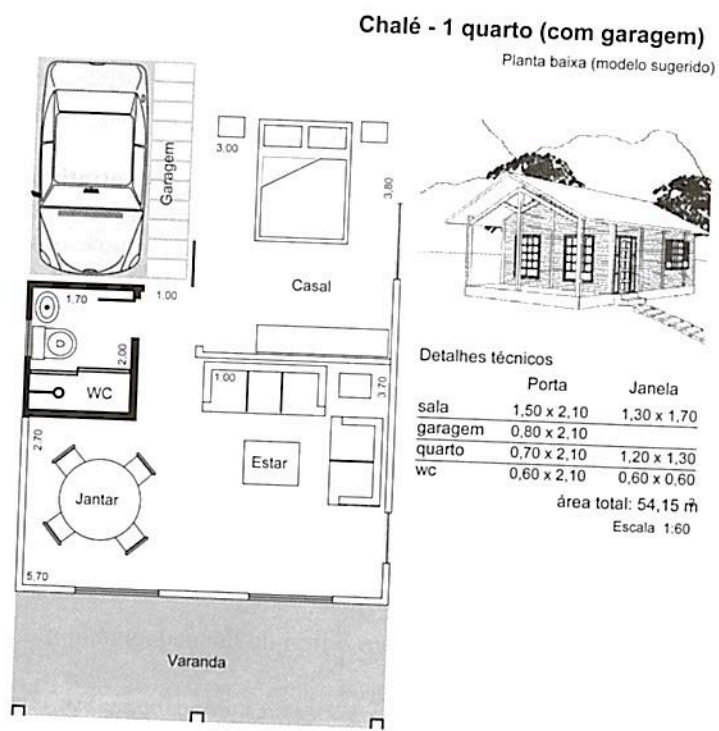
| Planta de um modelo de hospedagem tipo chalé
